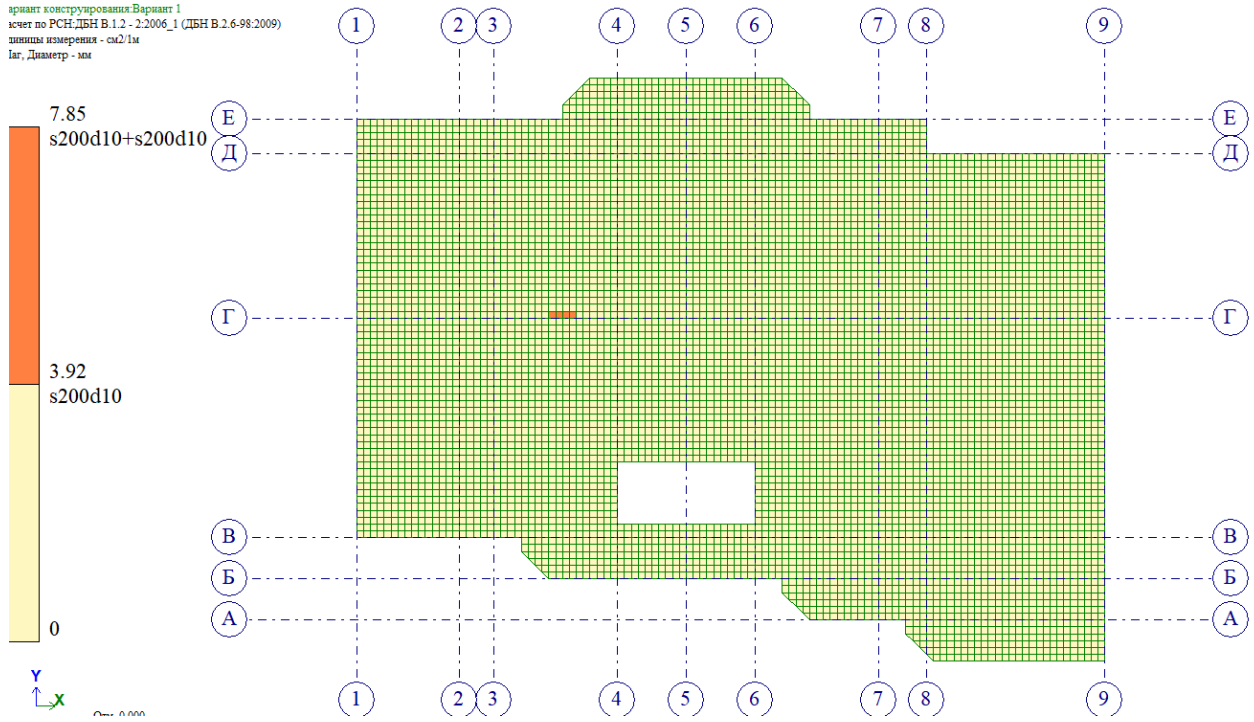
Армуння плити перекриття по нижній грані вздовж осі Y
